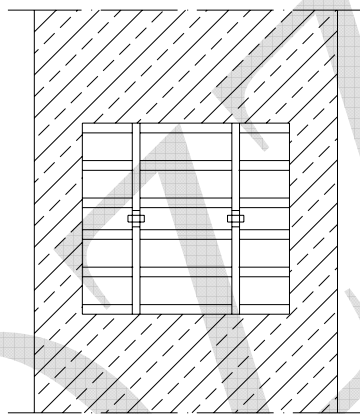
Vista in prospettiva di catena binata aderente al muro trasversale a livello del solaio
